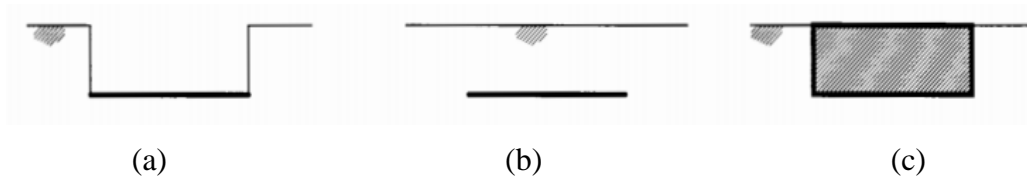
16–Les cas d'encastrement. (a) poutre d'un tranchée (cas d'une fondation spudcan). (b) fondation couverte. (c) contacte parfait avec le sol latéral (cas d'une fondation à base gravitaire).
